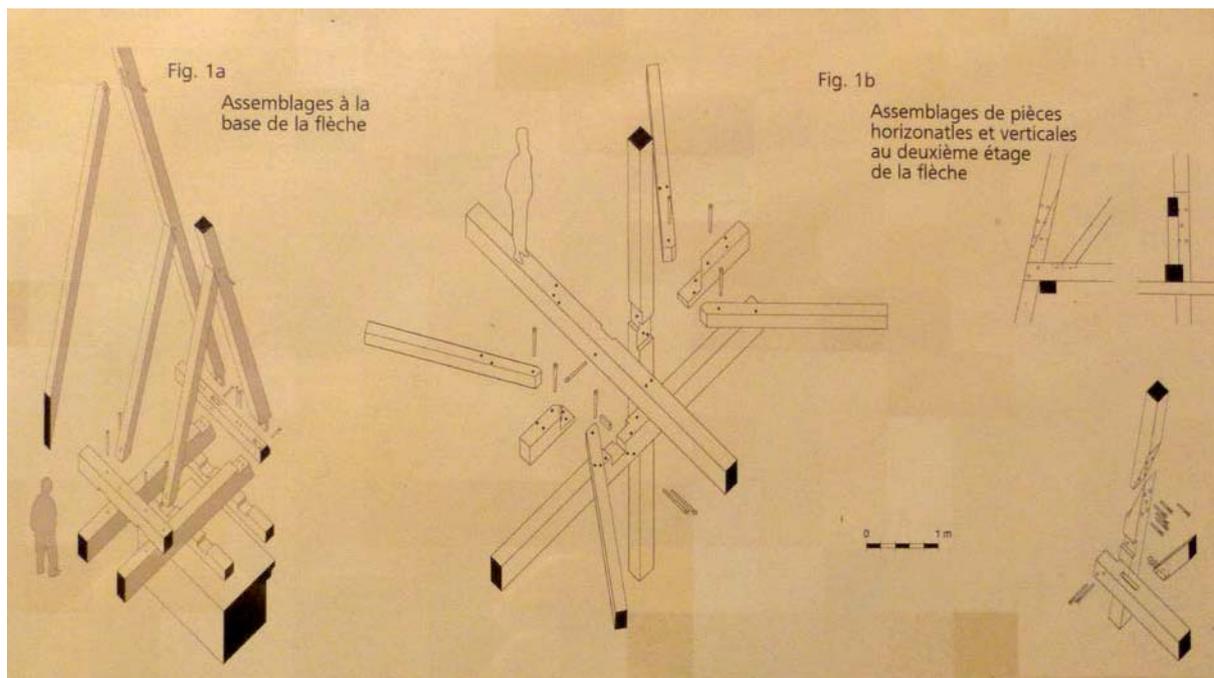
detalles de ensambles del arranque de la aguja y del segundo entramado. Idem anterior
